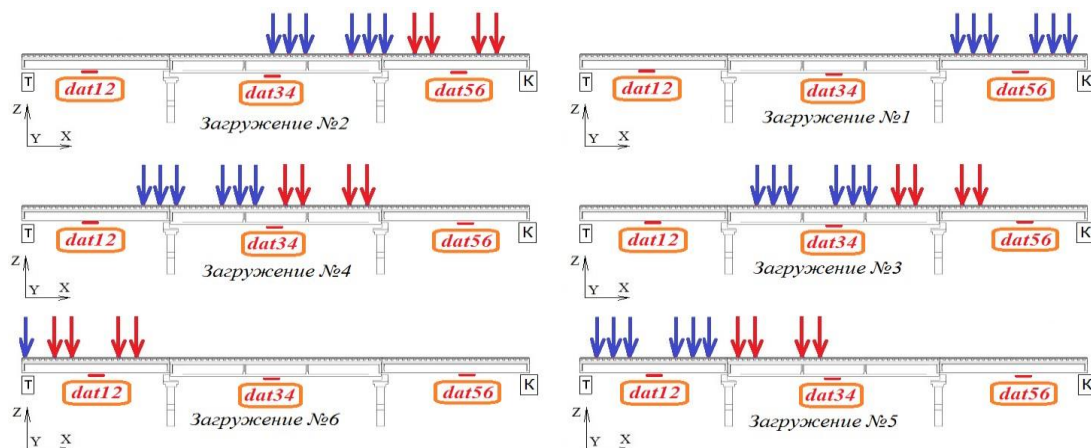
Схемы временных нагрузок от сцепа «тепловоз + вагон» (Загрузки № 1-6), dat 1, 2, 3, 4, 5, 6 – тензорезисторы установленные на пролетных строениях путепровода; К, Т – станции до и после путепровода
